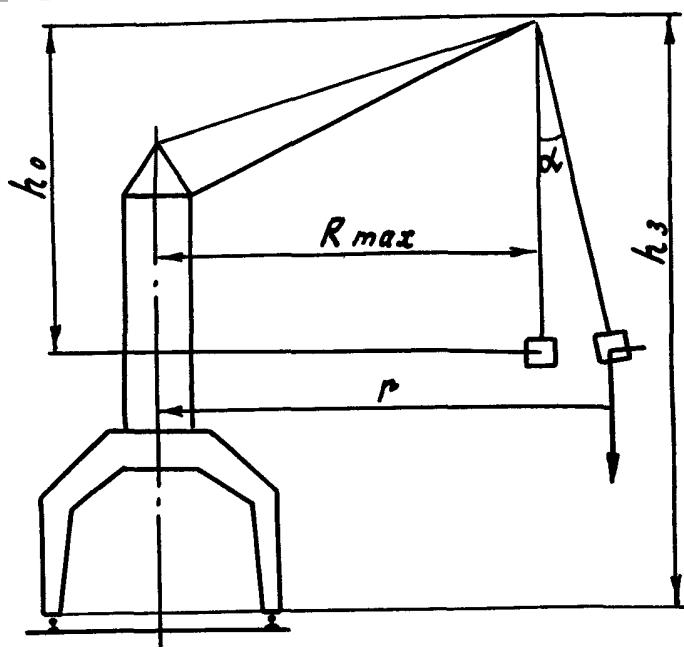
Схема к расчету устойчивости железнодорожного крана
